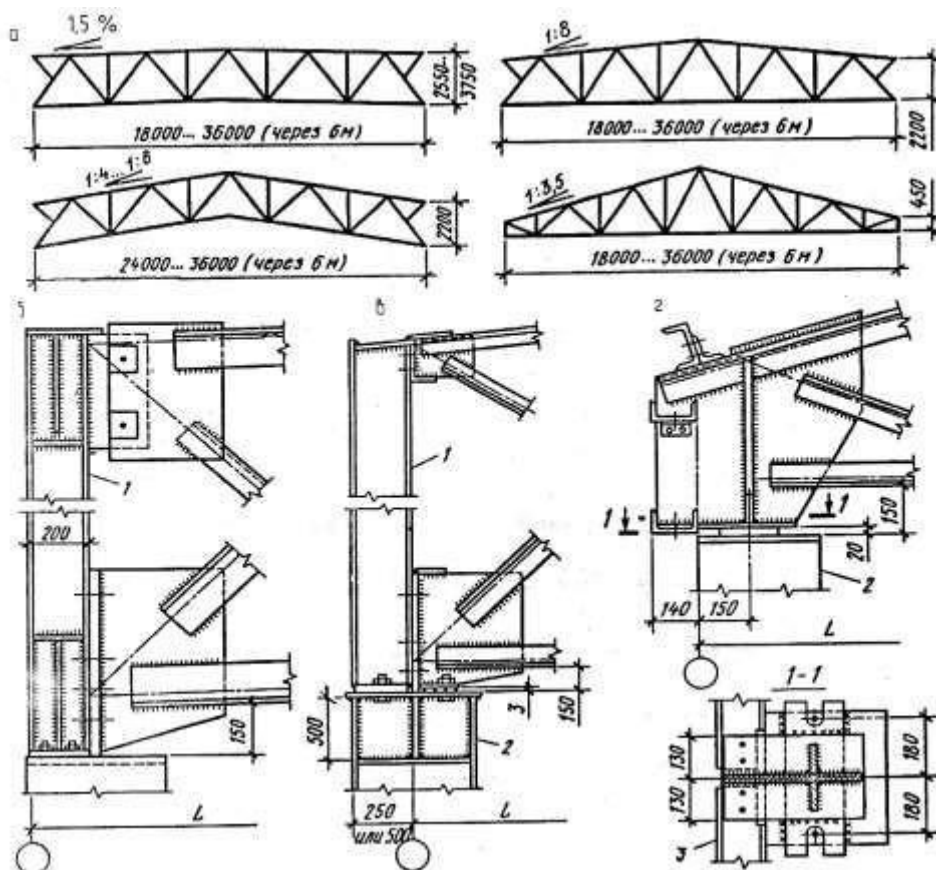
Сталеві кроквяні ферми: а — основні типи ферм; б — вузол спирання на колону
